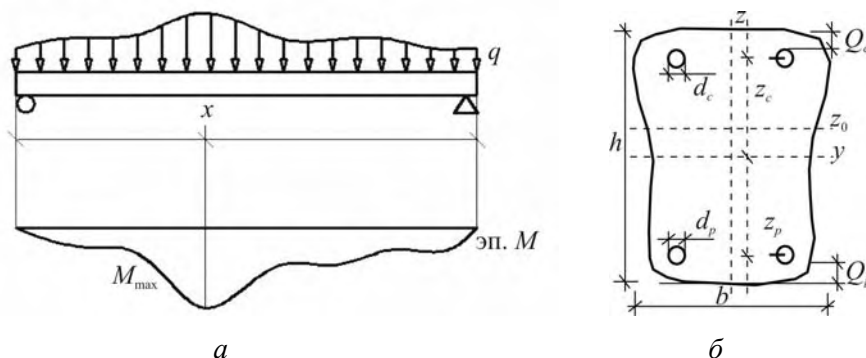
Расчетная схема балки (а), поперечное сечение балки (б)
